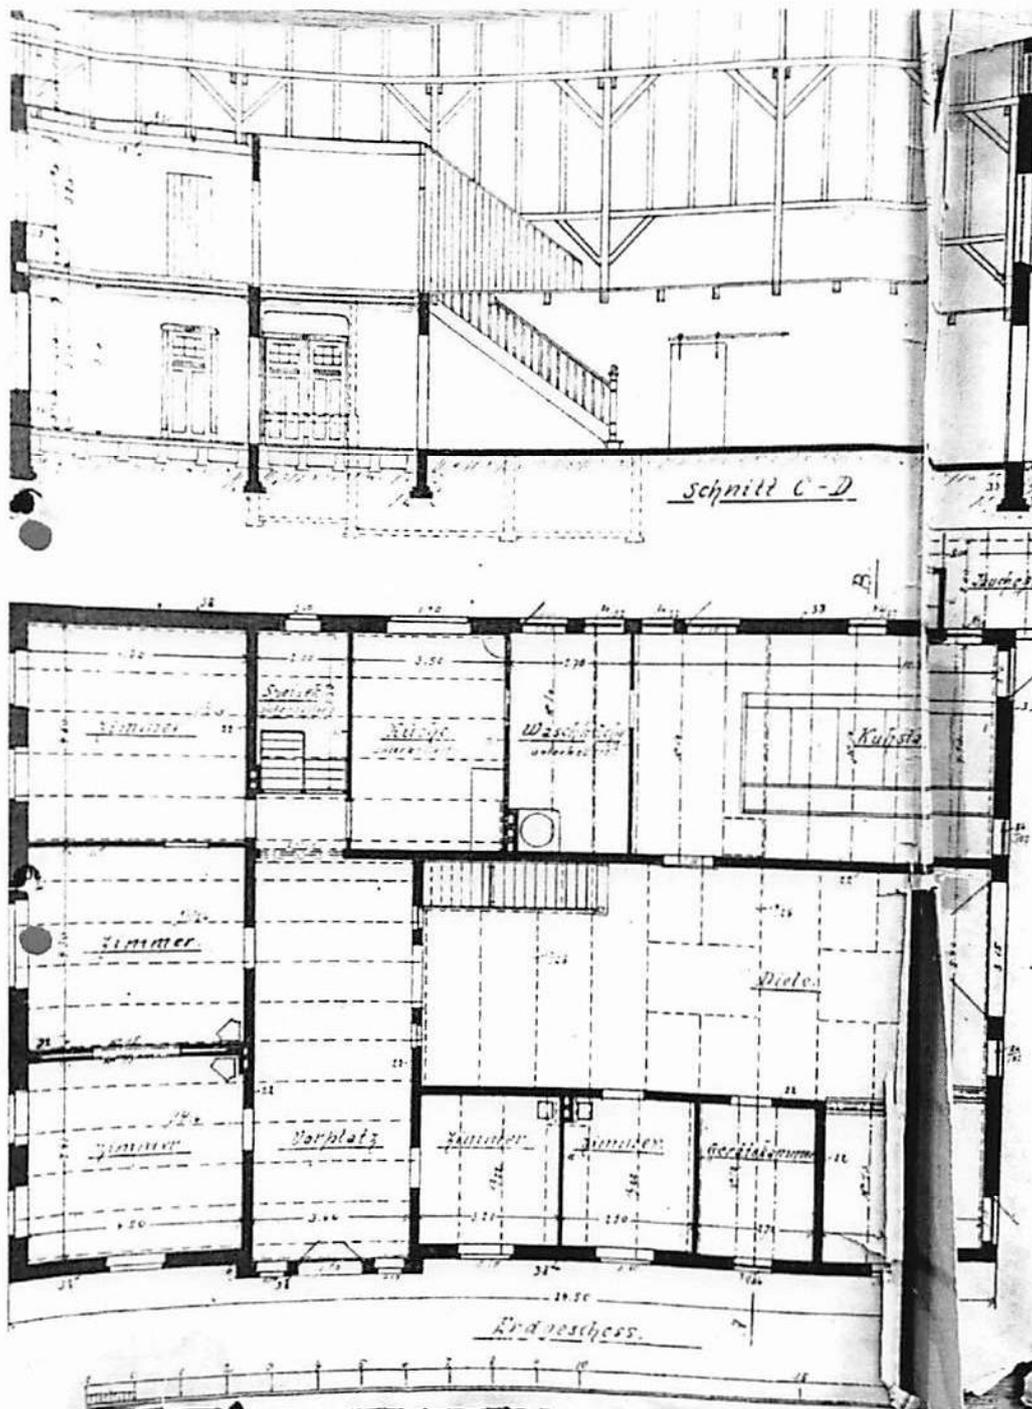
Grundrisse / Schnitte Wohngebäude
